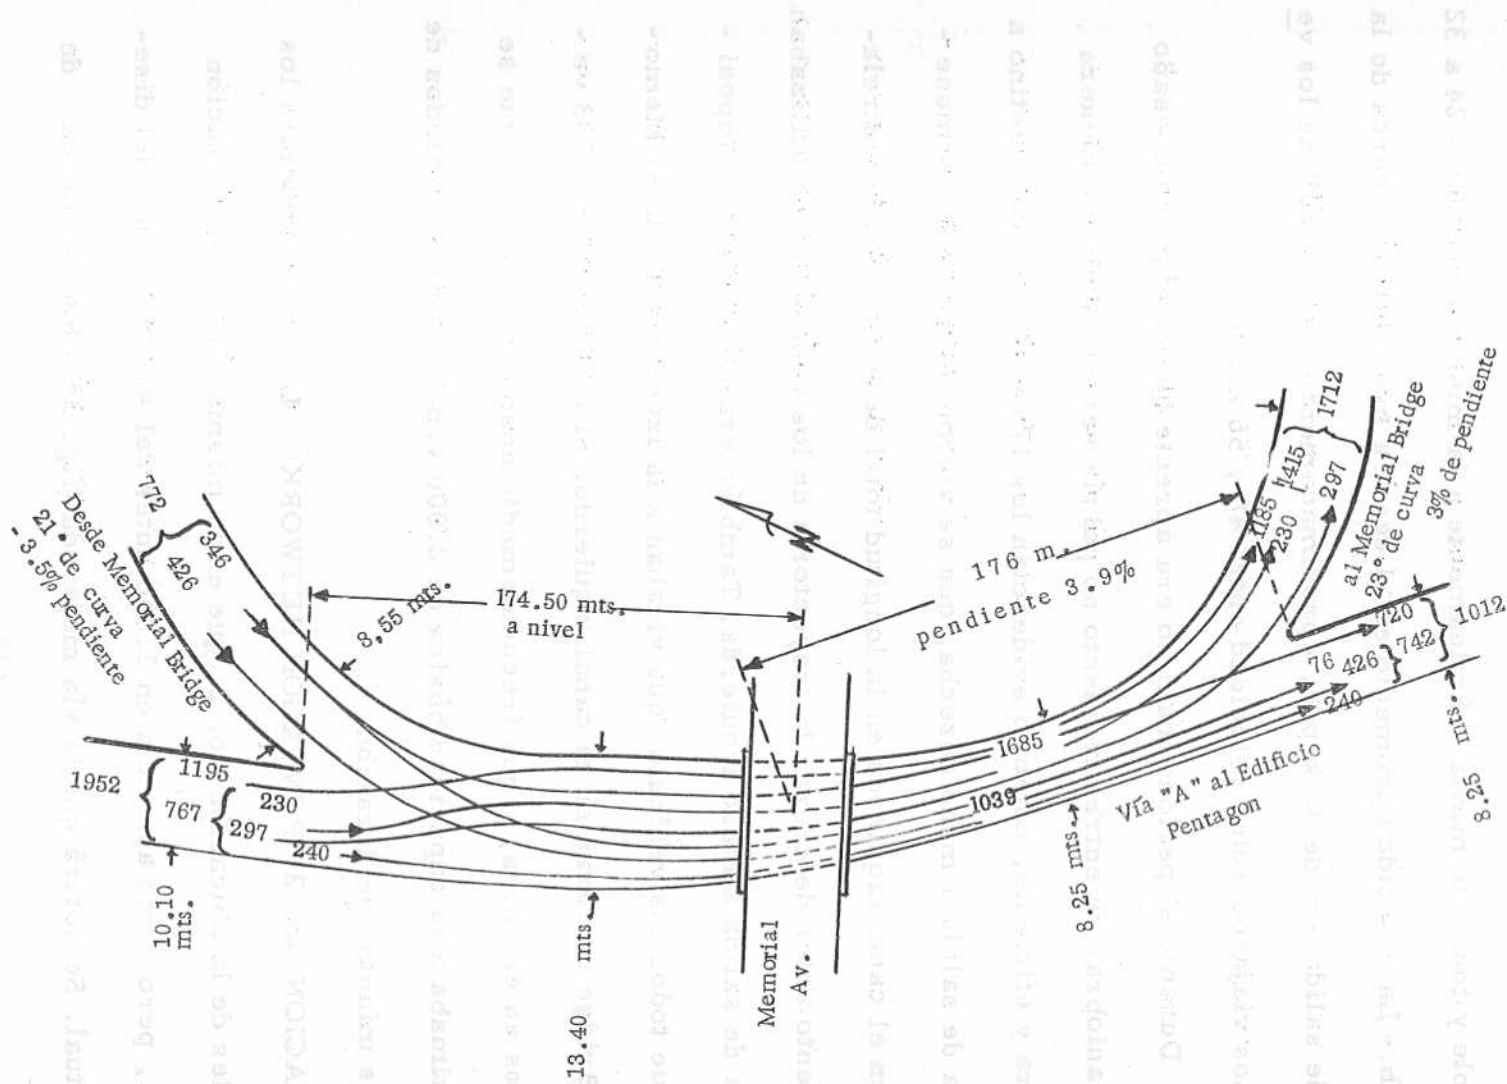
Máximo volumen horario observado en una sección de canal mixto, en la carretera que pasa por debajo del Memorial Avenue cerca del extremo oeste del Memorial Bridge, Washington D.C.
